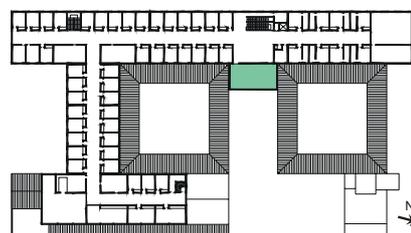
Localização da Sala Capitular na obra construída. Segundo pavimento. (Desenho da autora).
